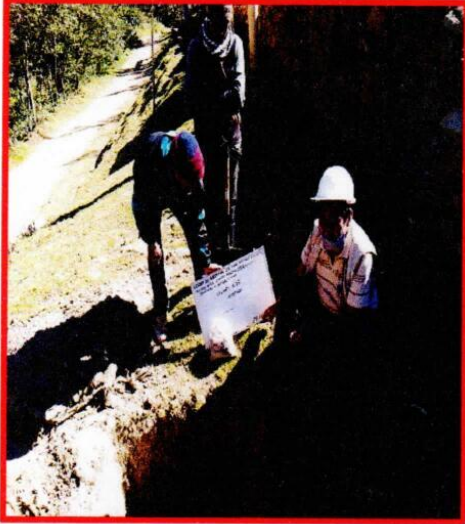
Foto N° 13. Detalle del perfil del suelo en Calicata C-7.
